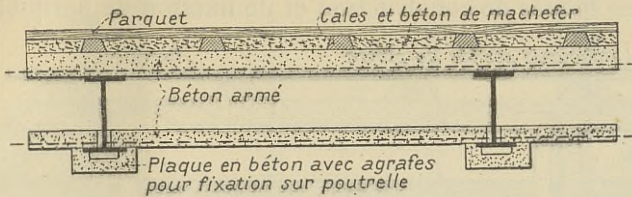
Poutrelles en fer, hourdis coulé sur place, plaques de plafonnage moulées à l'avance.
